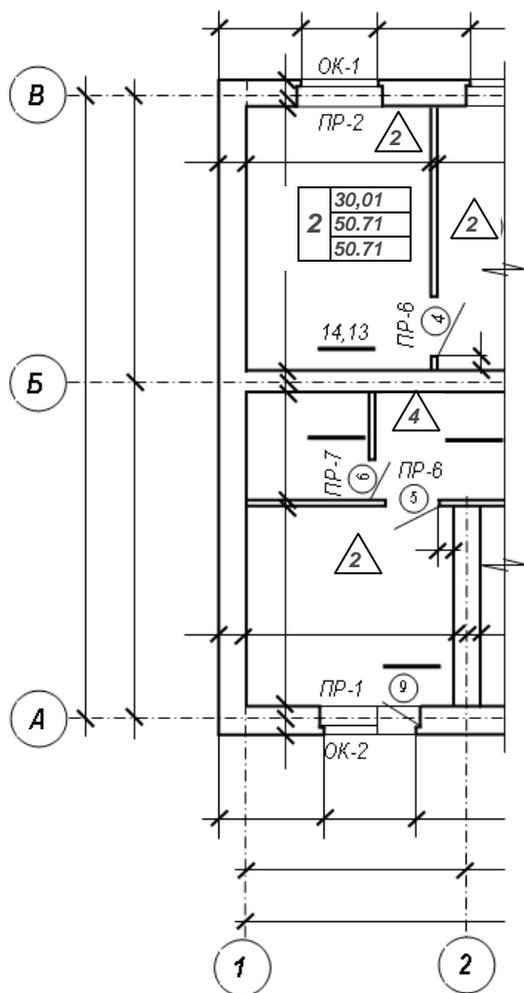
Пример оформления плана этажа жилого дома со стенами из кирпича или крупных блоков
